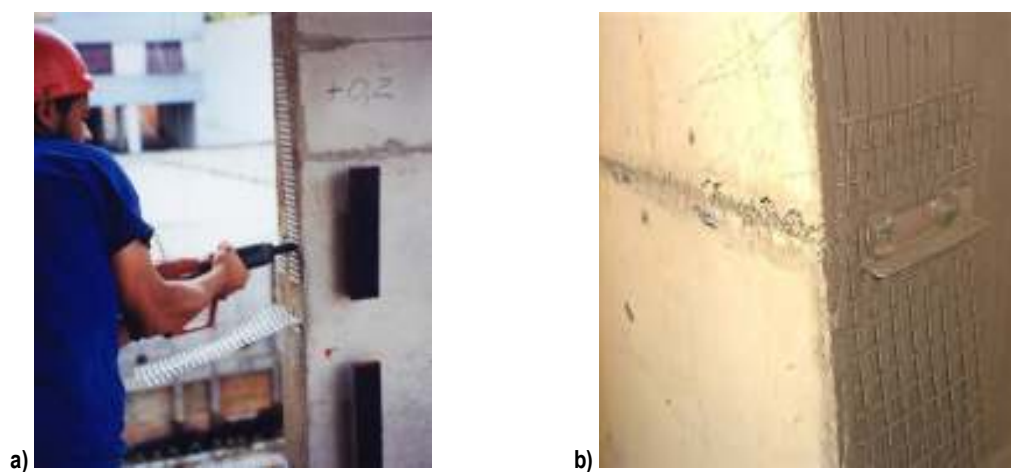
Telas metálicas: a) fixação ao pilar, b) cantoneira
